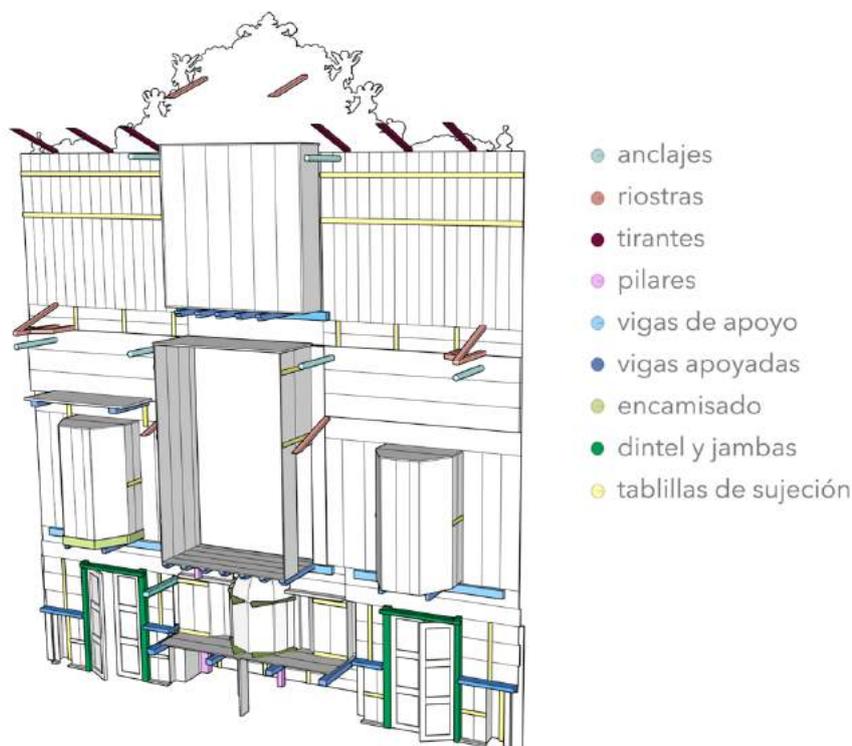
Elementos estructurales del sistema constructivo de caja arquitectónica o lámina. Vista posterior del retablo mayor de la Iglesia de San Francisco.
